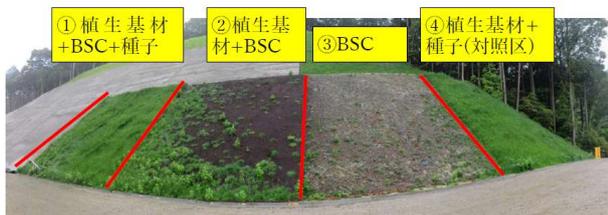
試験施工箇所の全体写真 (施工後6.5カ月後)
